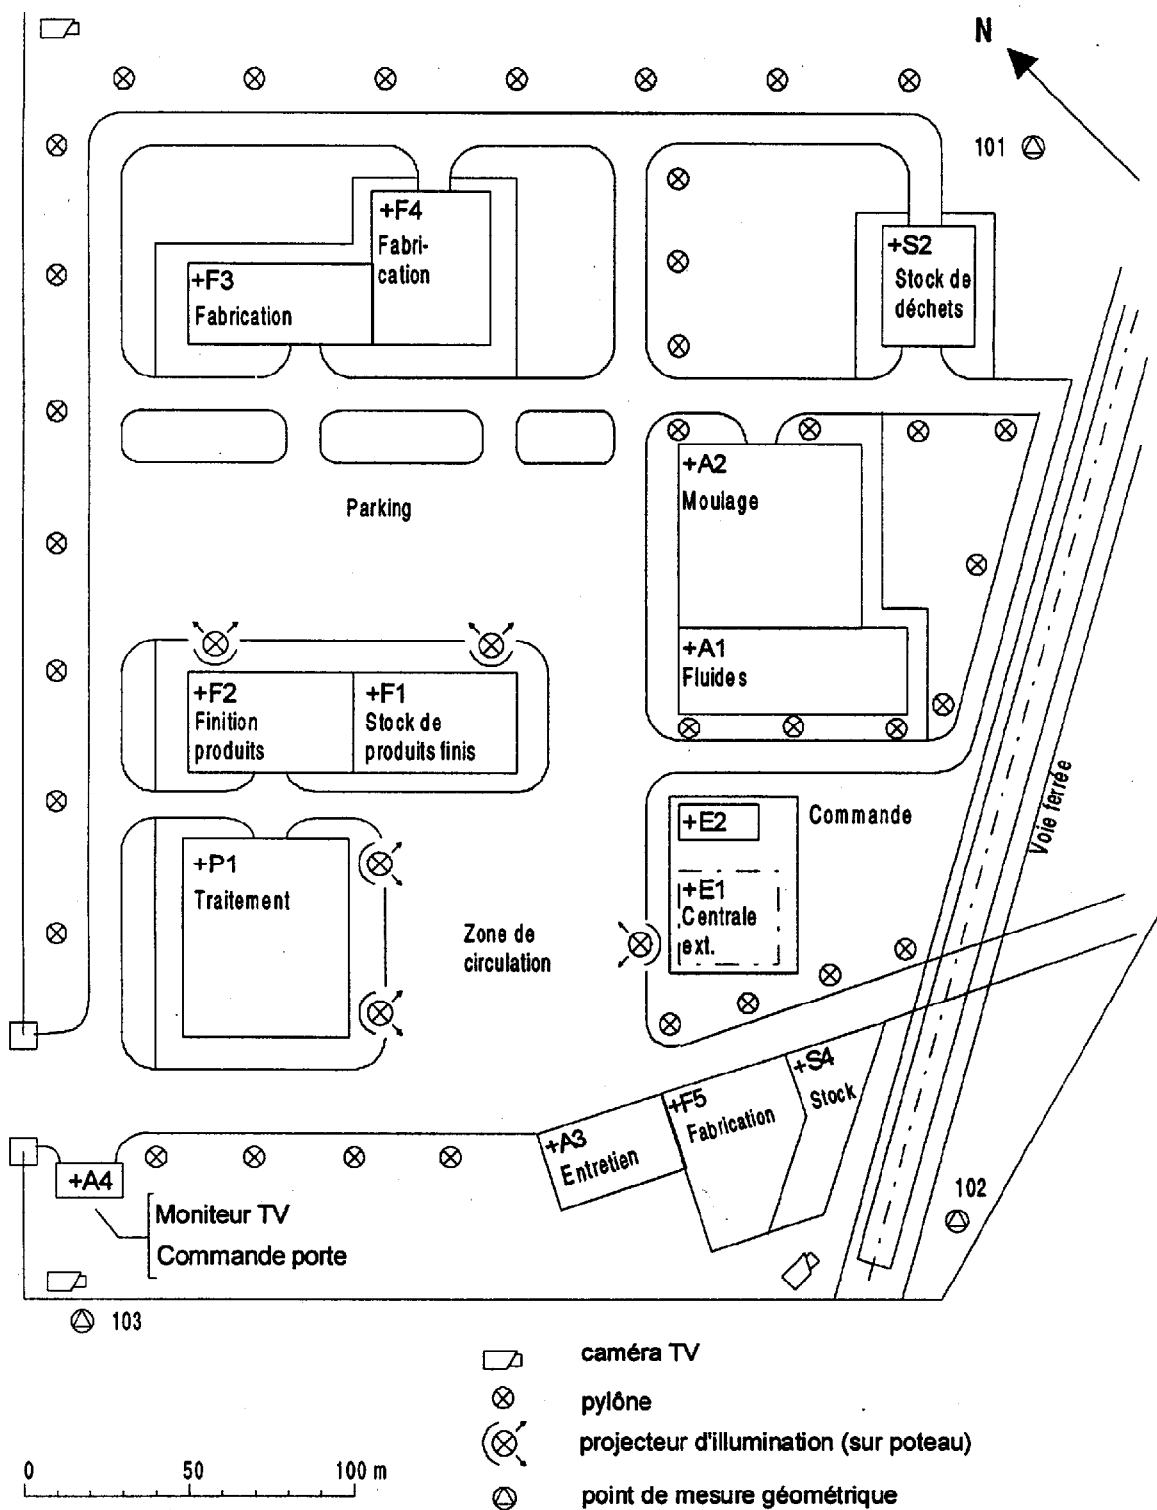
Exemple de dessin de disposition d'un site: Installation Industrielle (voir 5.2.1)
